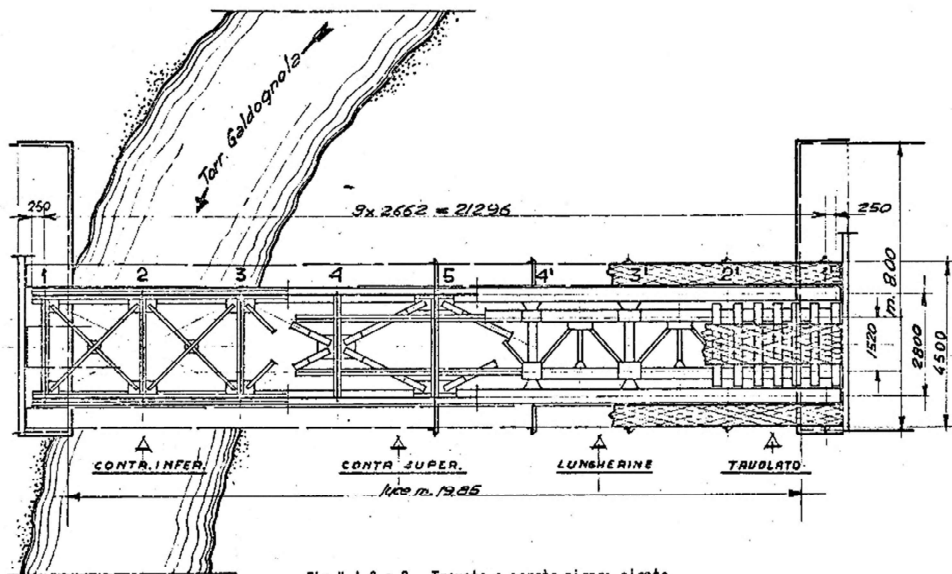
a-2 - Travata a parete piena: pianta
